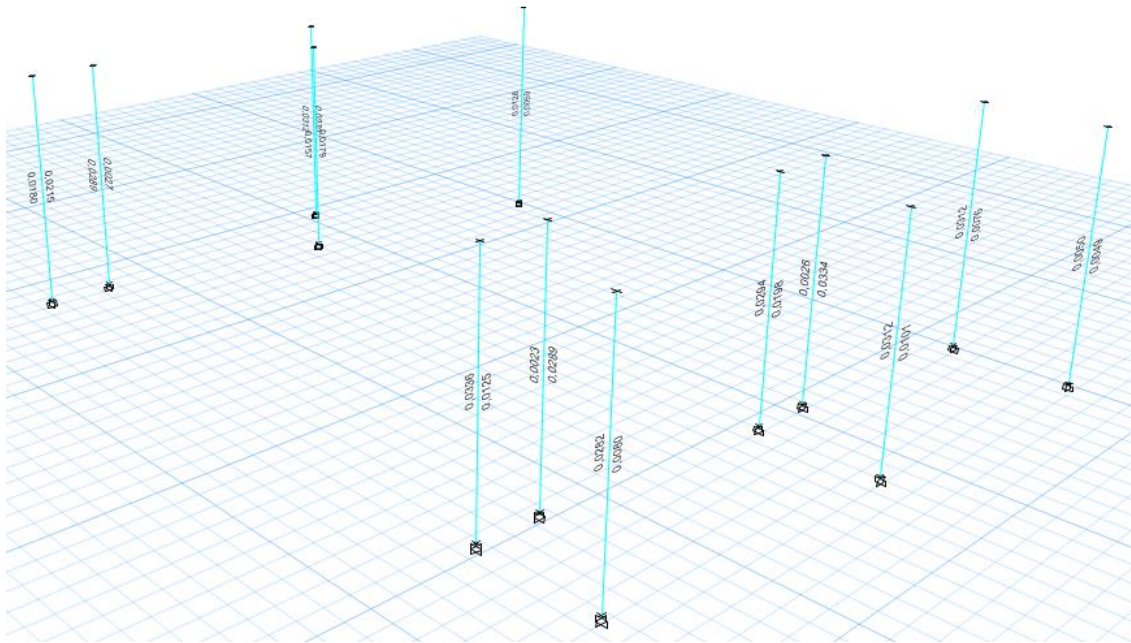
Refuerzo longitudinal columnas las aulas bilingüismo en %
